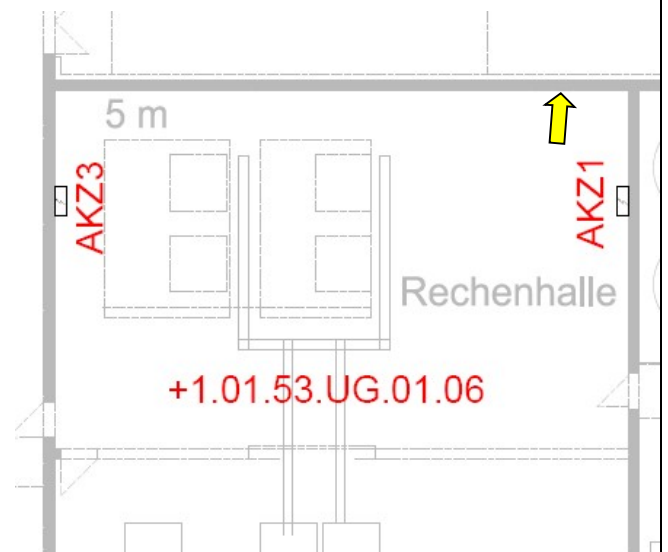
Brandschutzklappe Lage in der Rechenhalle Süd
